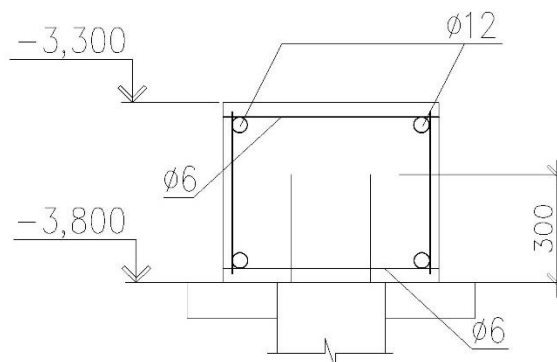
Схема армирования поперечного сечения ростверка
